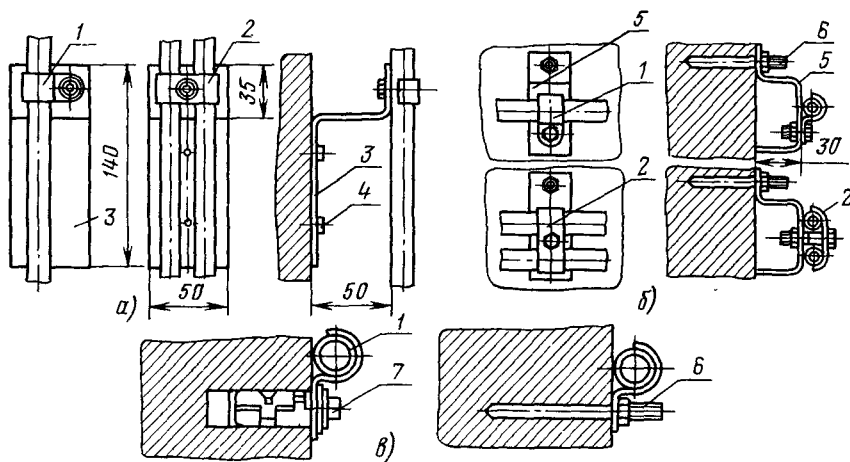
Крепление одиночных трубных проводов диаметром от 8 до 14 мм на бетонных и кирпичных основаниях:
